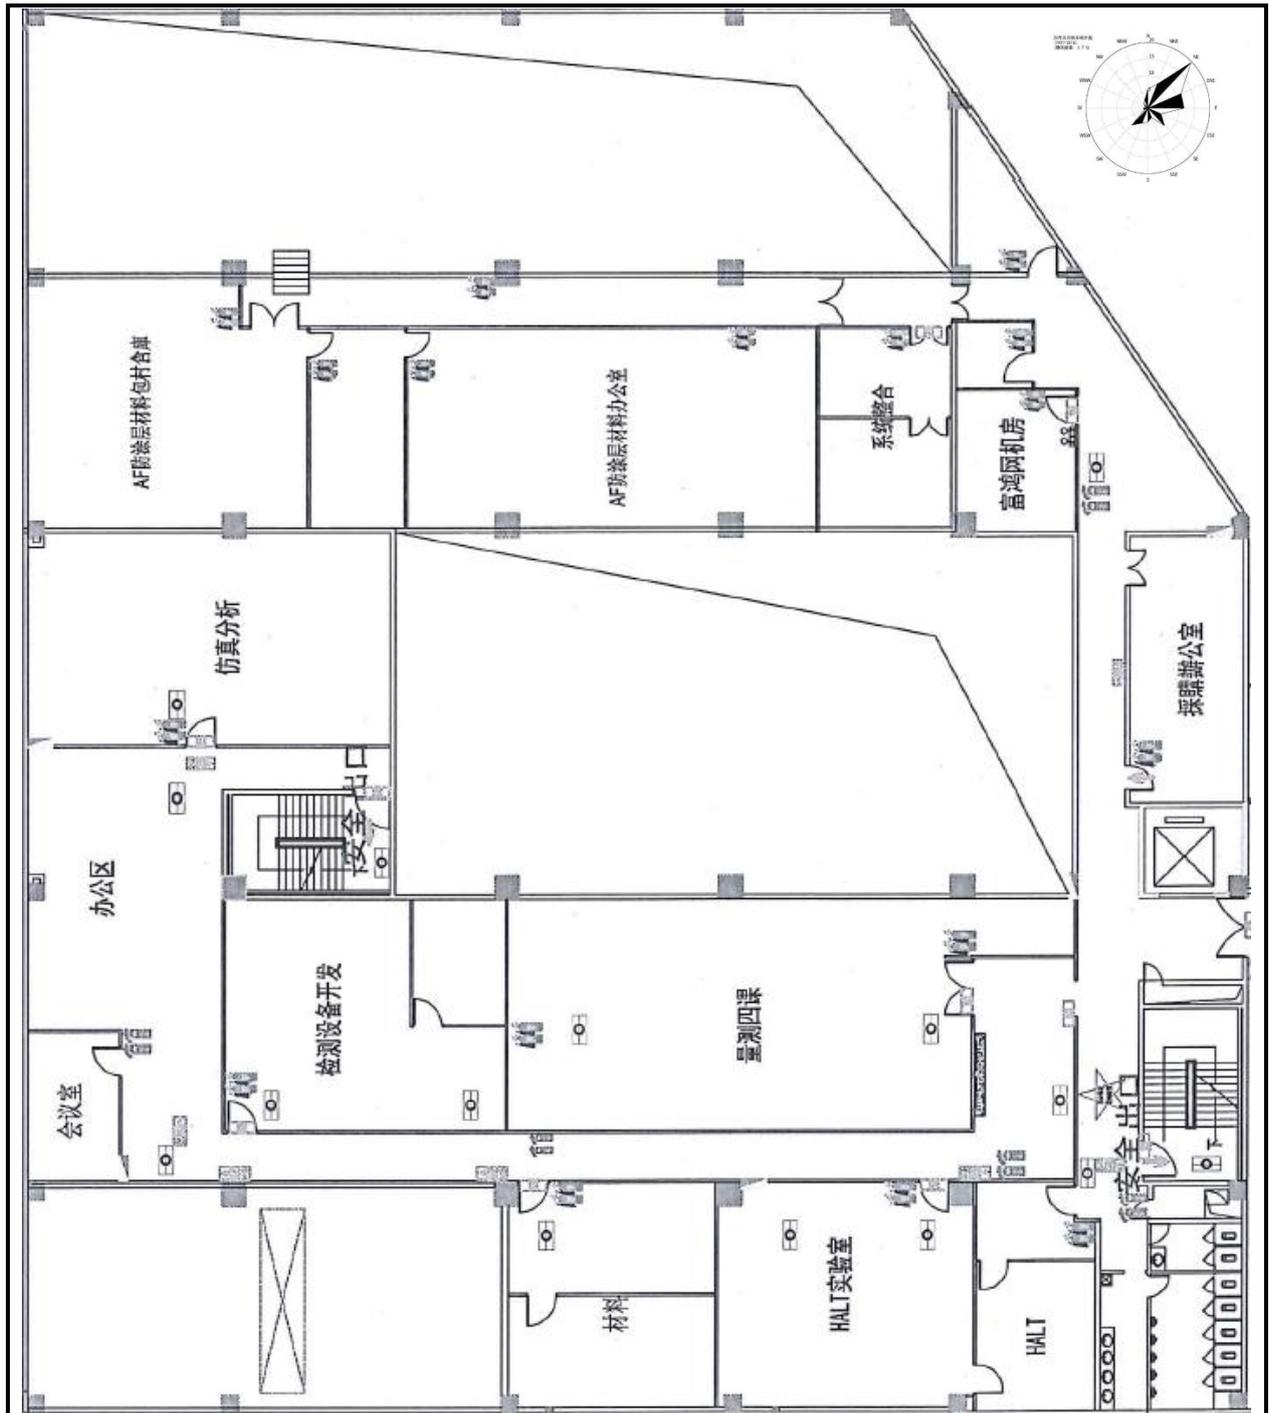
项目 G6 区厂房 2 层 A 车间平面布置图
